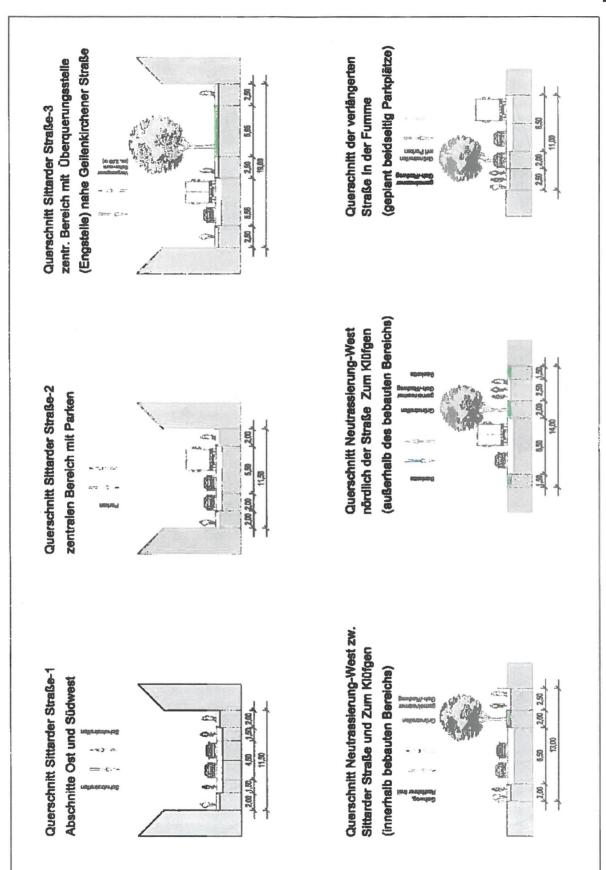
Konkretisierung geplante Straßenquerschnitte Sittarder Straße, Neutrassierung, In der Fummer
